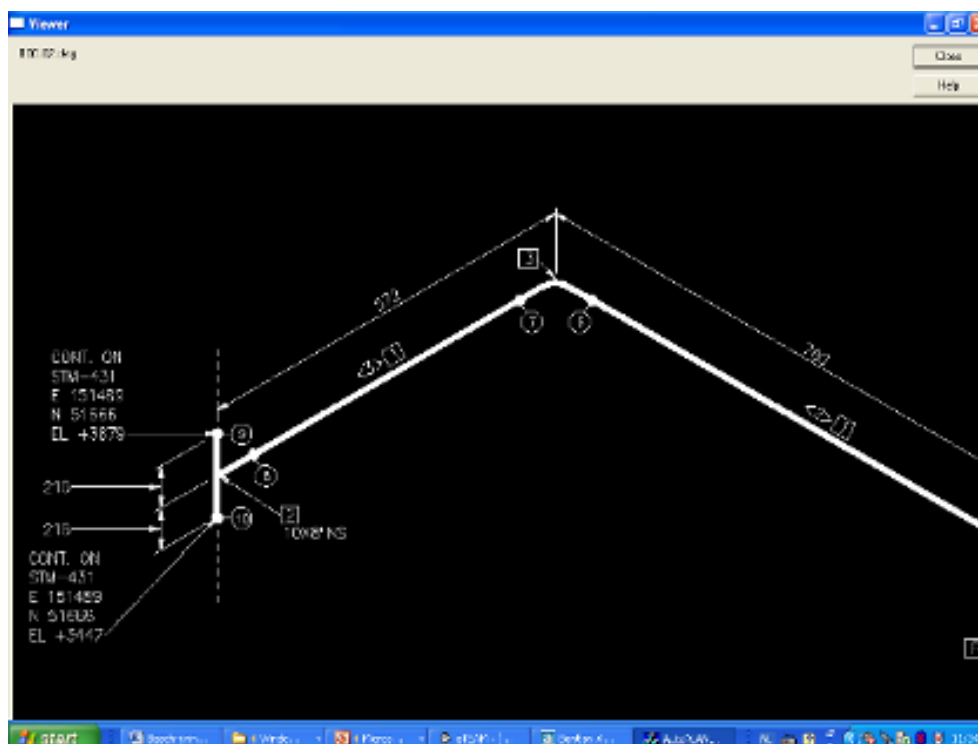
Tubería existente con su inclinación *as built* corregida © BnS engineering N.V.
